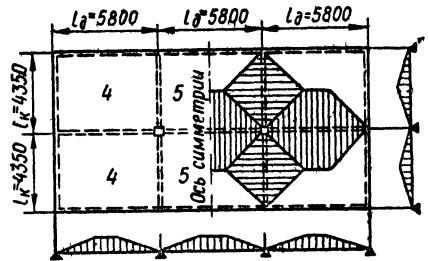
Расчетные схемы балок кессонных перекрытий
